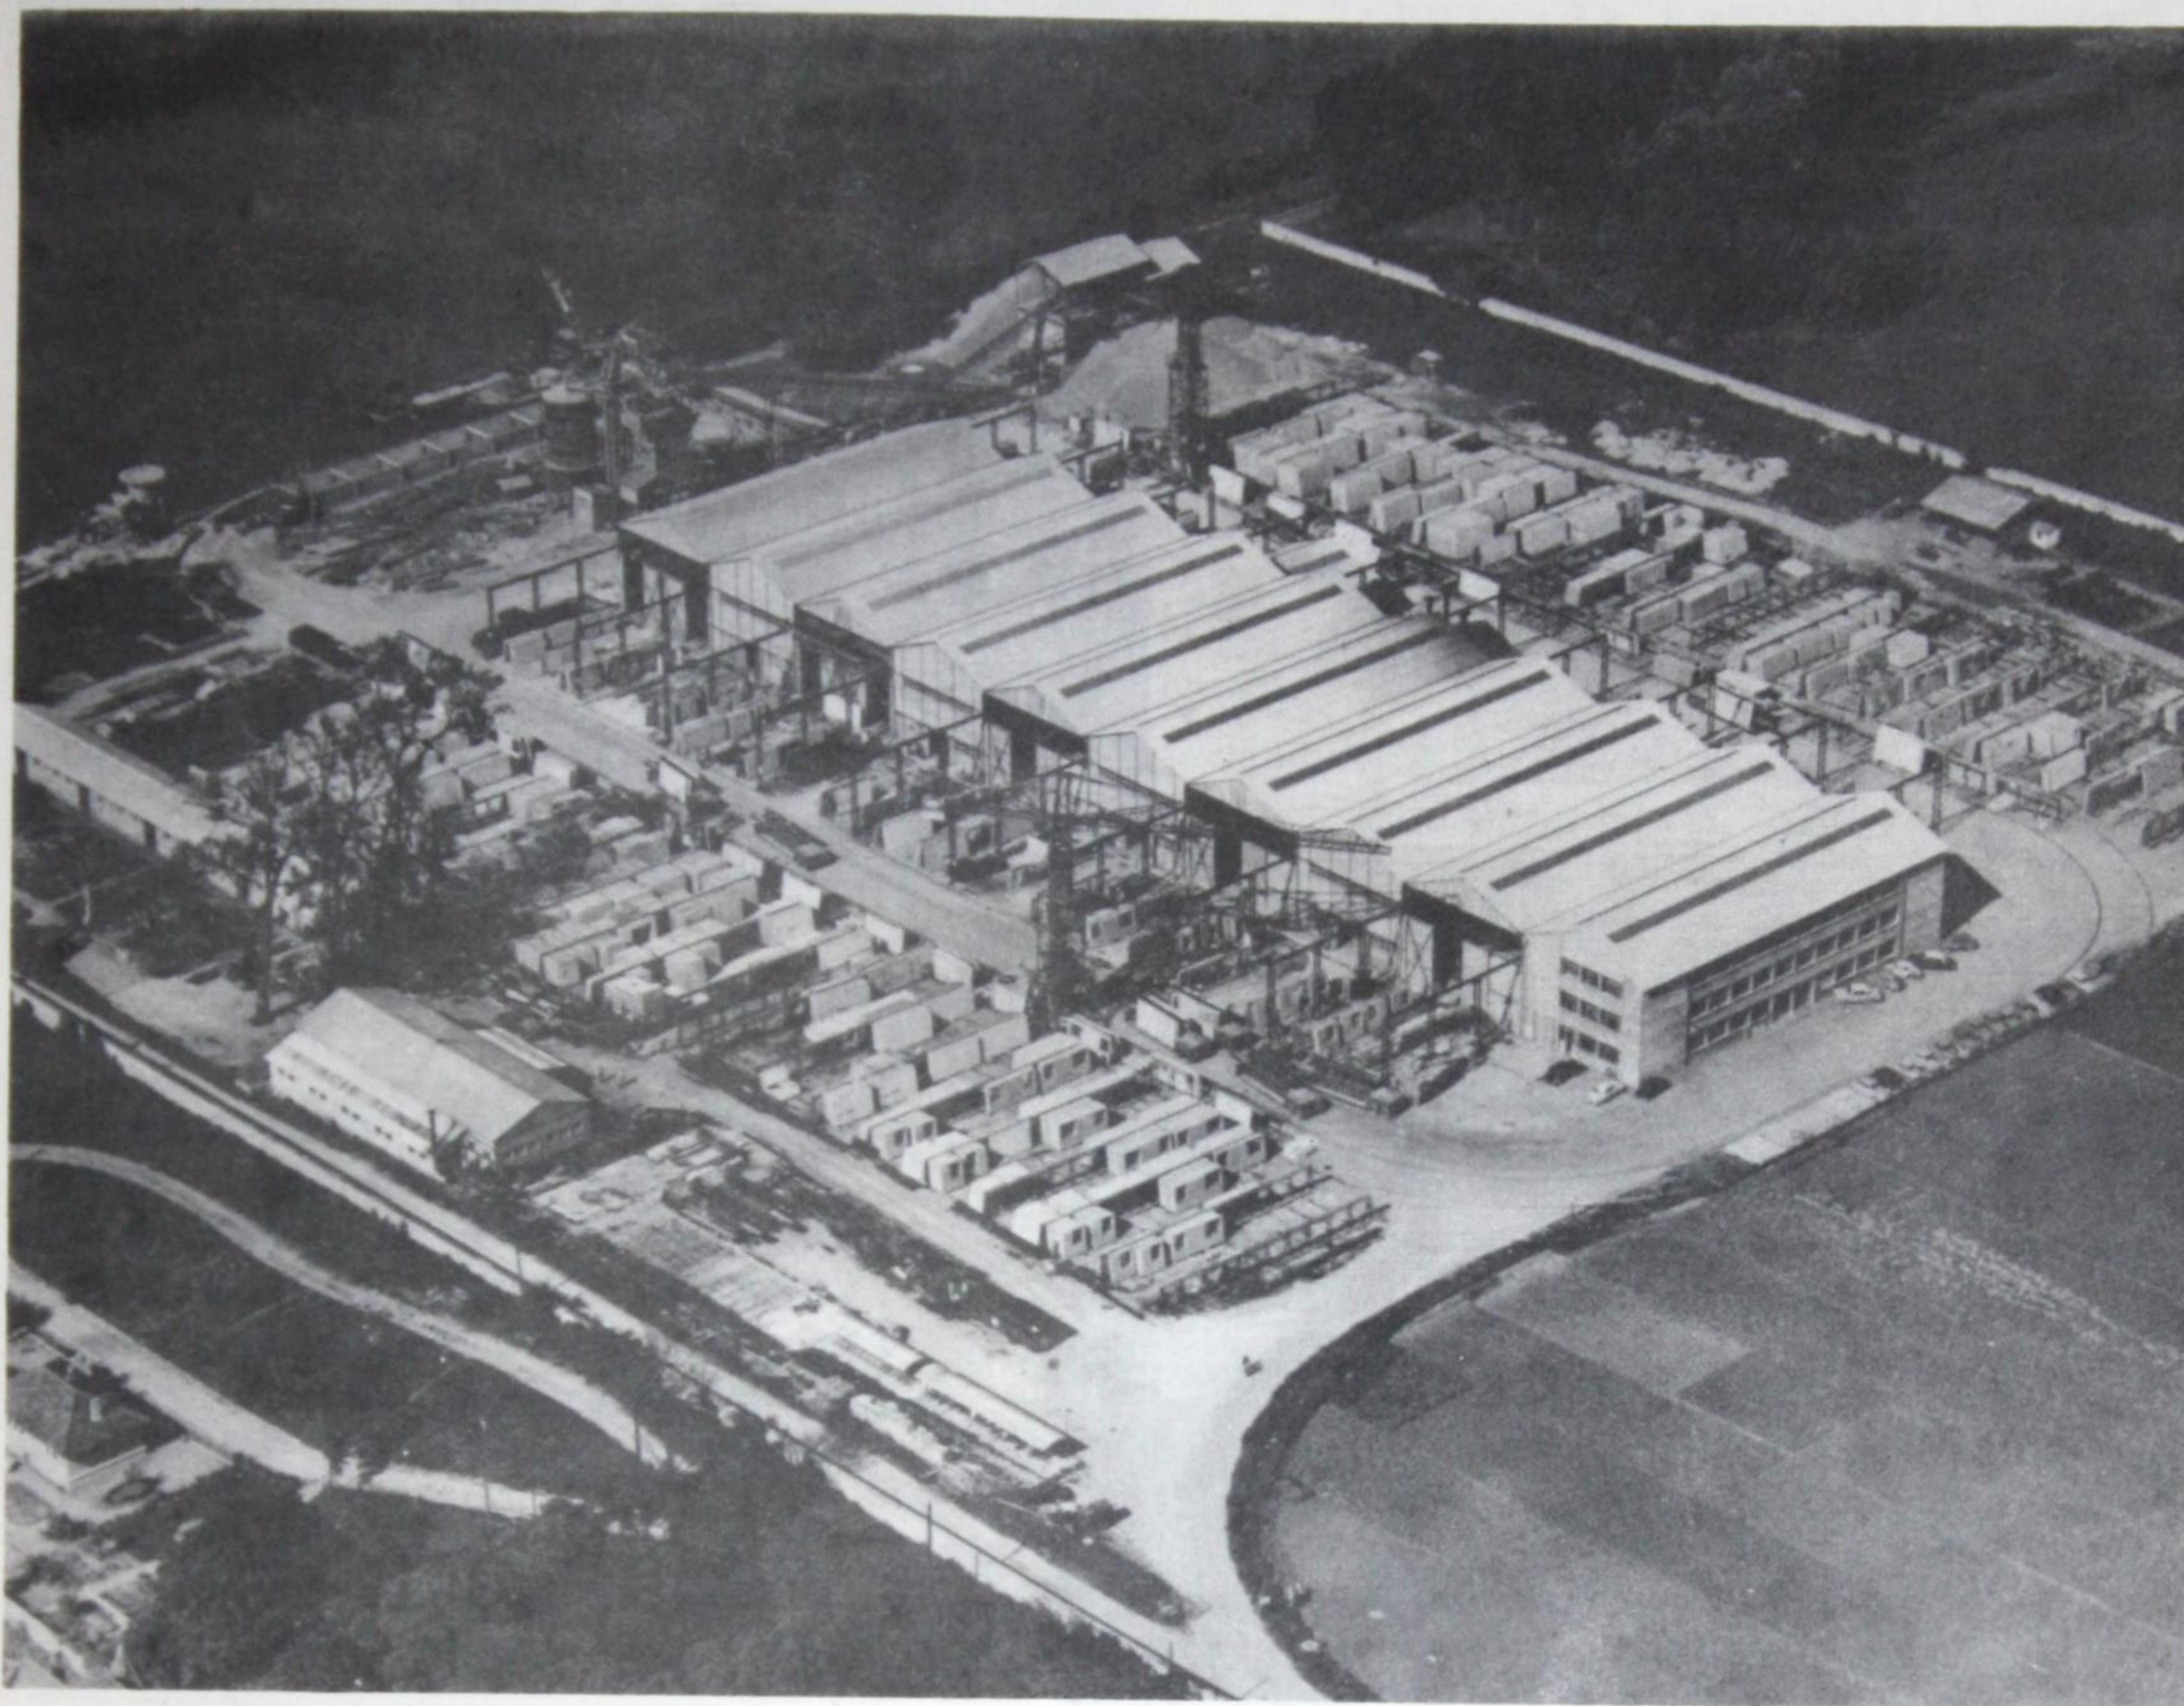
Vue générale aérienne d'une usine (SERPEC à Montesson)
